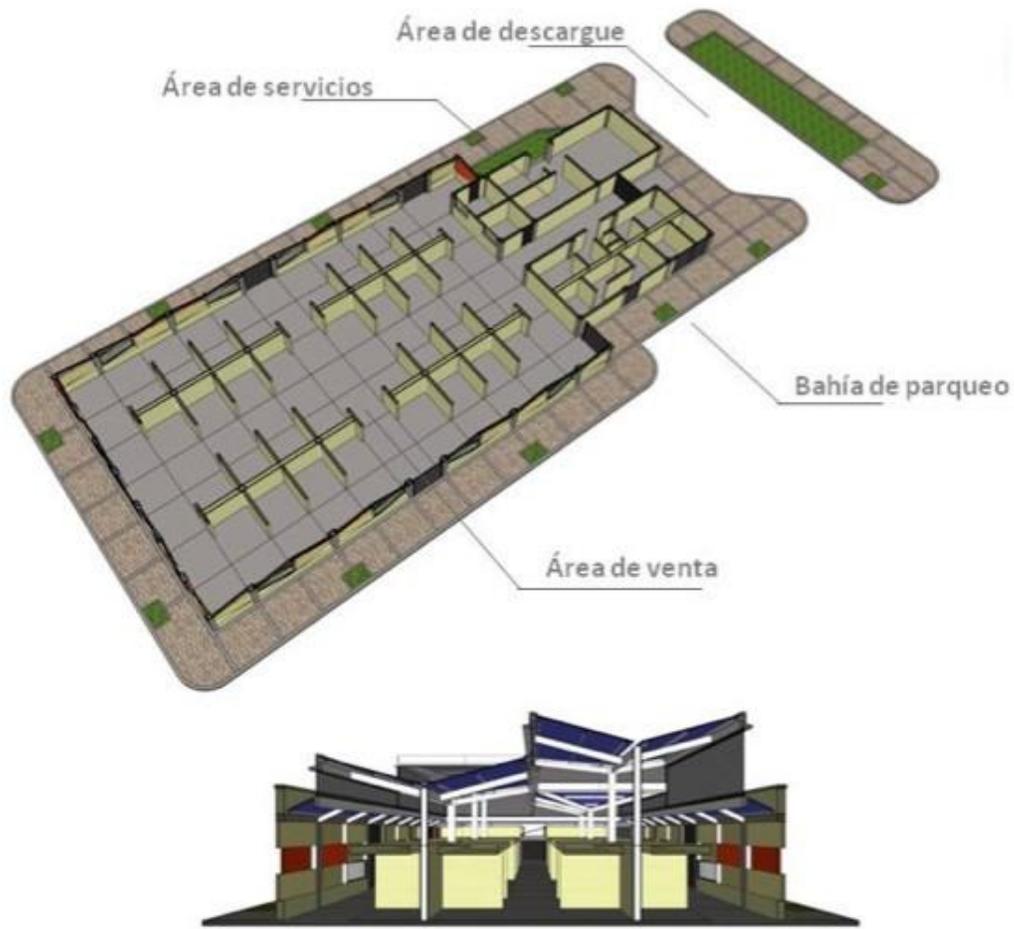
Plaza de Mercado Tipología 2. Fuente: Consorcio INGEOMAR.
